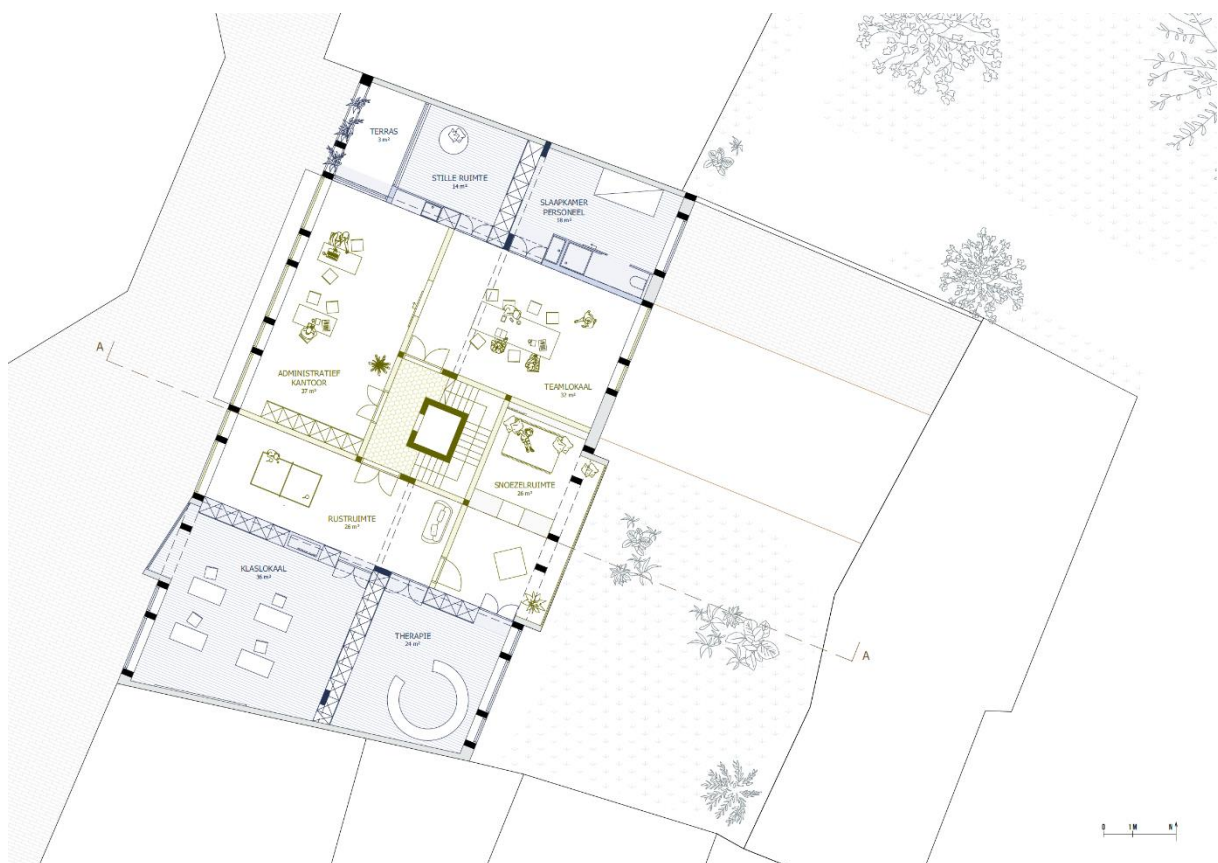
Plan eerste verdieping De Korbeel Kortrijk. (VK Architects, z.d.)
